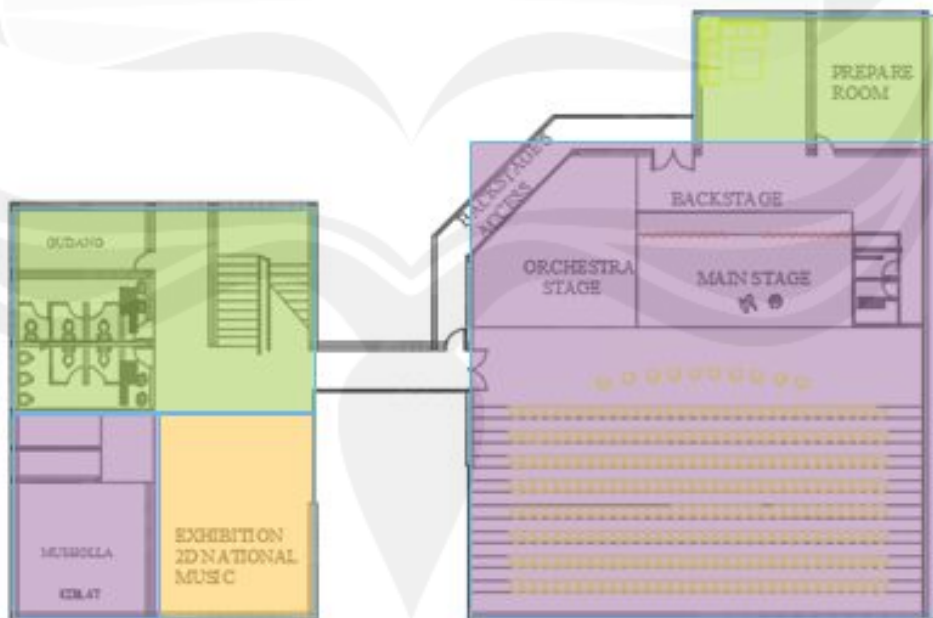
Kebutuhan Ruang Museum lantai 1
